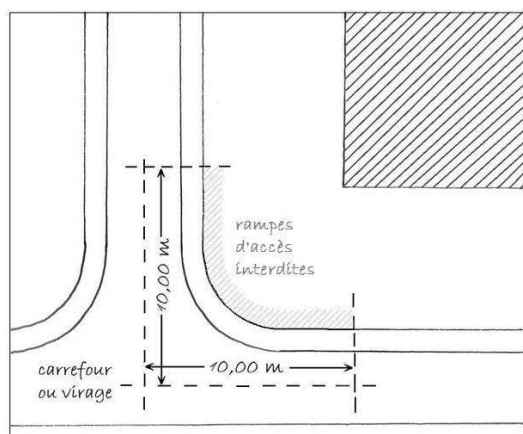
Rampes d'accès à proximité d'un carrefour ou d'un virage
